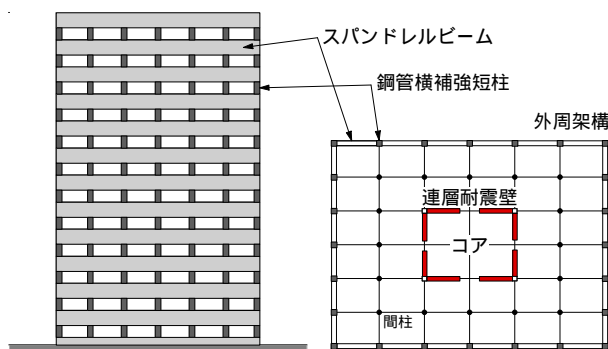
ひび割れ制御型RC系有壁架構の立面と平面
